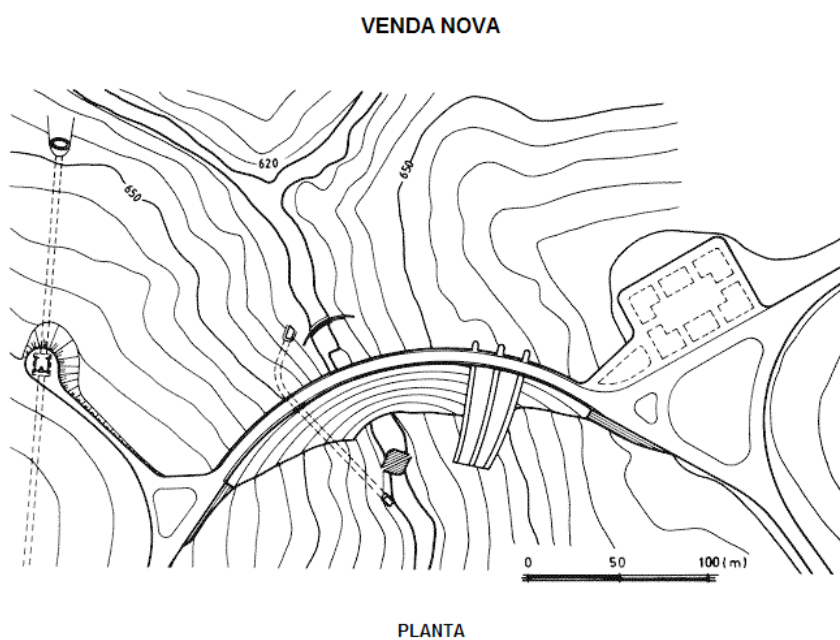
Barragem de Venda Nova – Planta [4]
